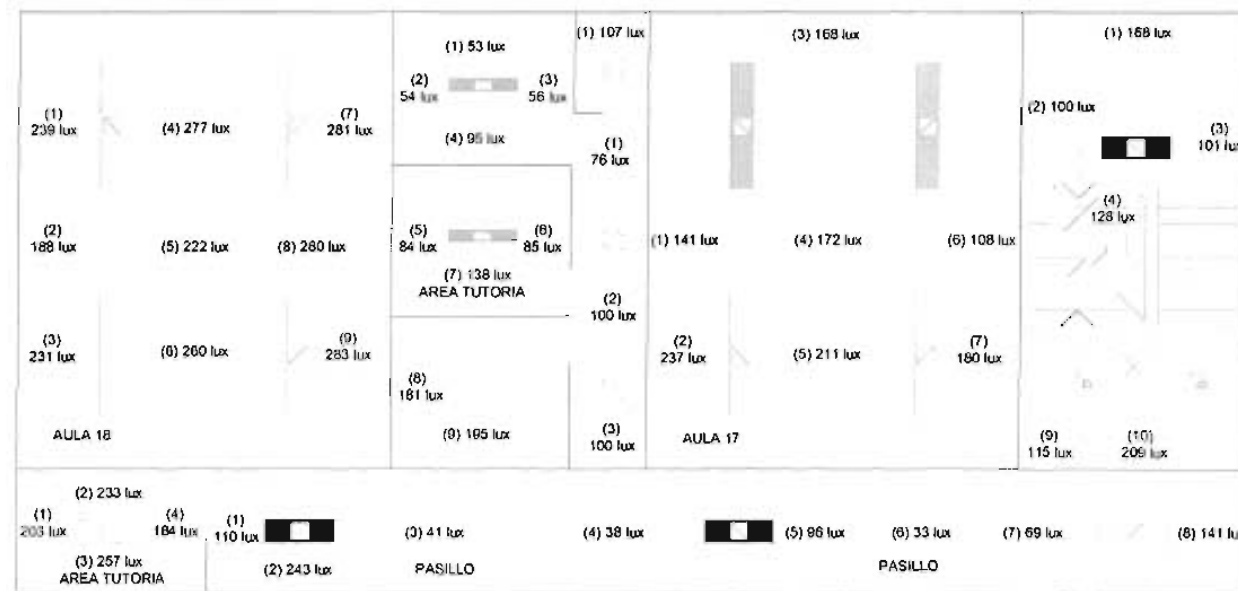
Medición de los Niveles de Iluminación planta baja Edificio B. Facultad de Contaduría y Administración de la UAC
